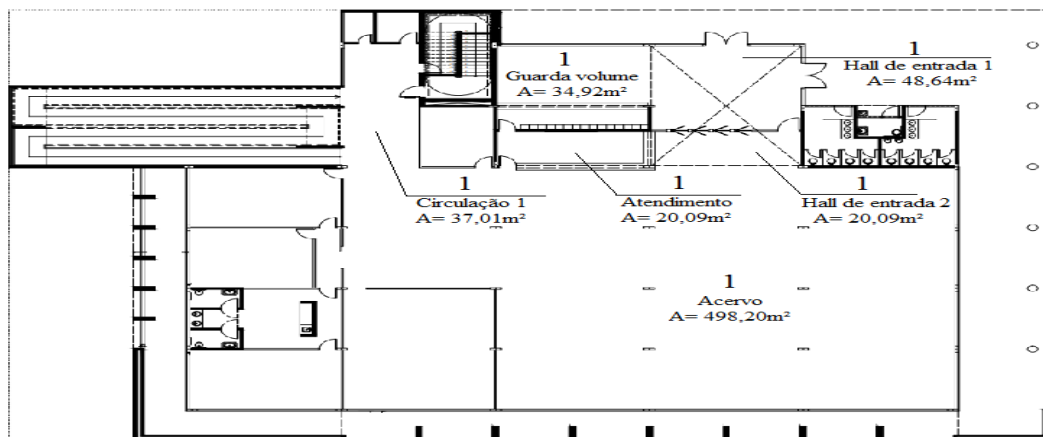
Planta baixa do pavimento inferior da biblioteca
